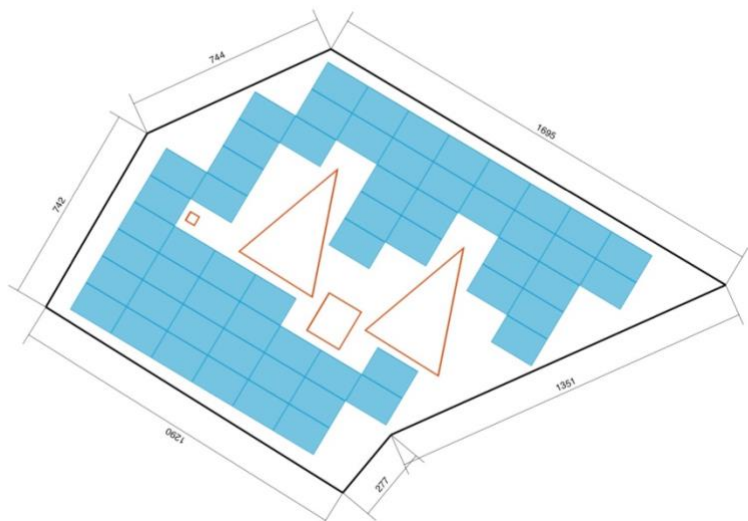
Rüeterswilerstrasse 49, Belegungsplan, Dachfläche 3: Süden
